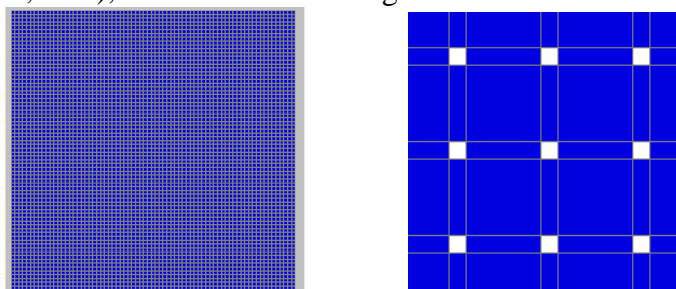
Vista frontal e em detalhe do treliçado com ripamento vertical e horizontal
